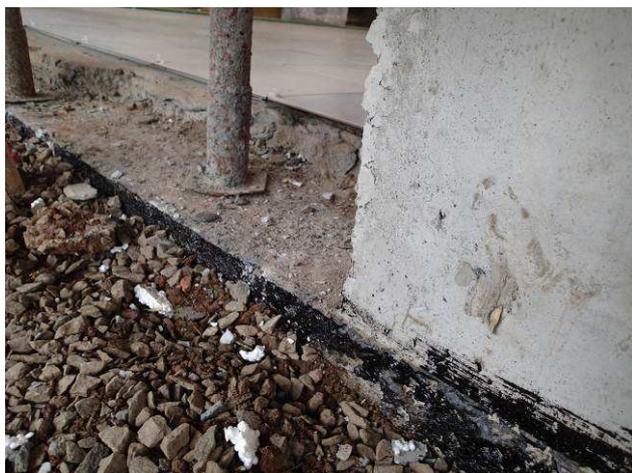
C: Vigas baldrame impermeabilizadas com pintura asfáltica.
